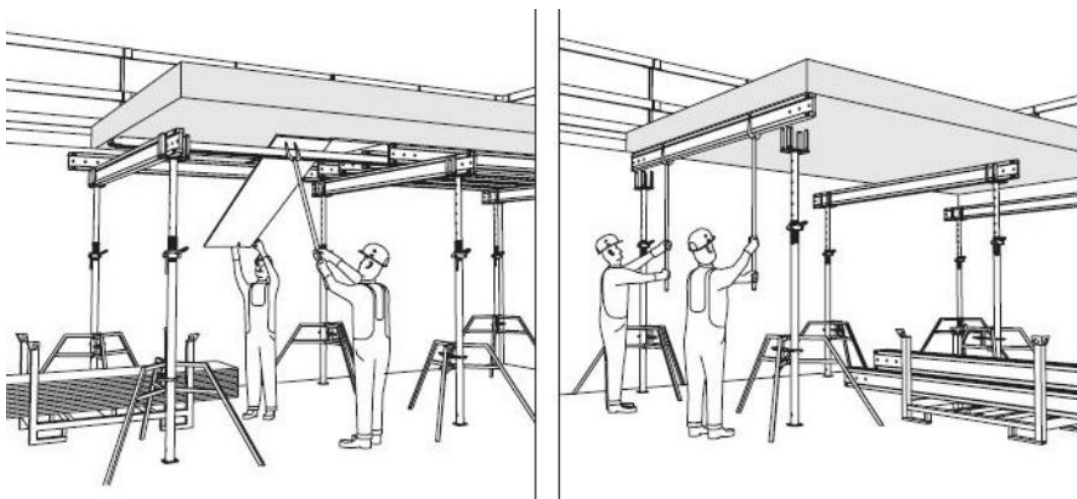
Odbednění stropní konstrukce - odstranění stojek
